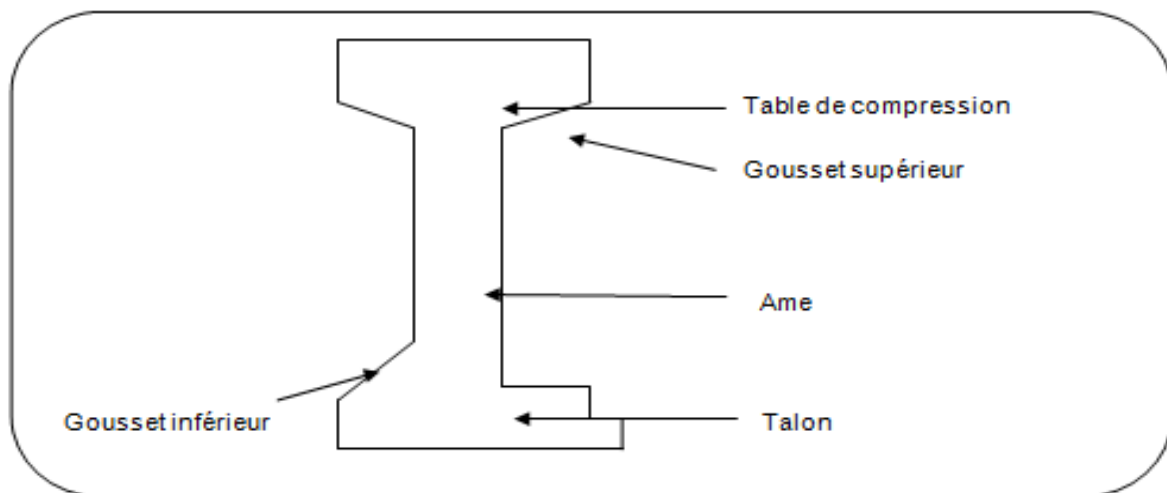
Terminologie et coupe transversale d'une notre poutre
